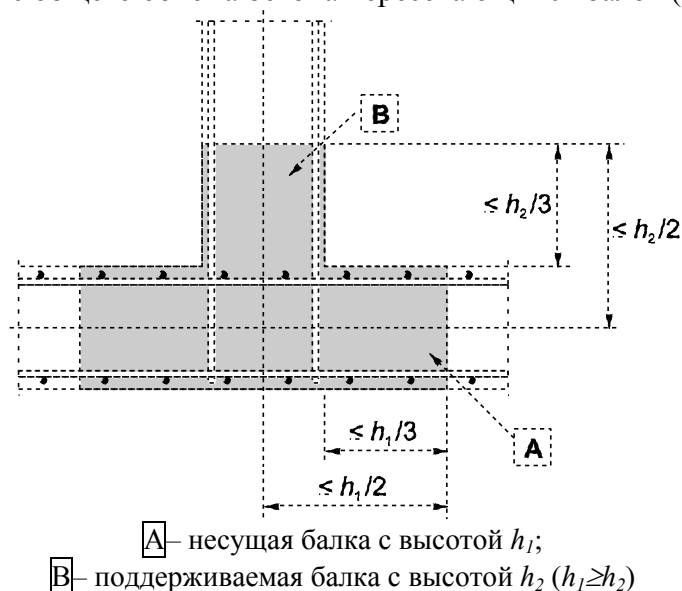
Размещение опорной арматуры в зоне пересечения двух балок
